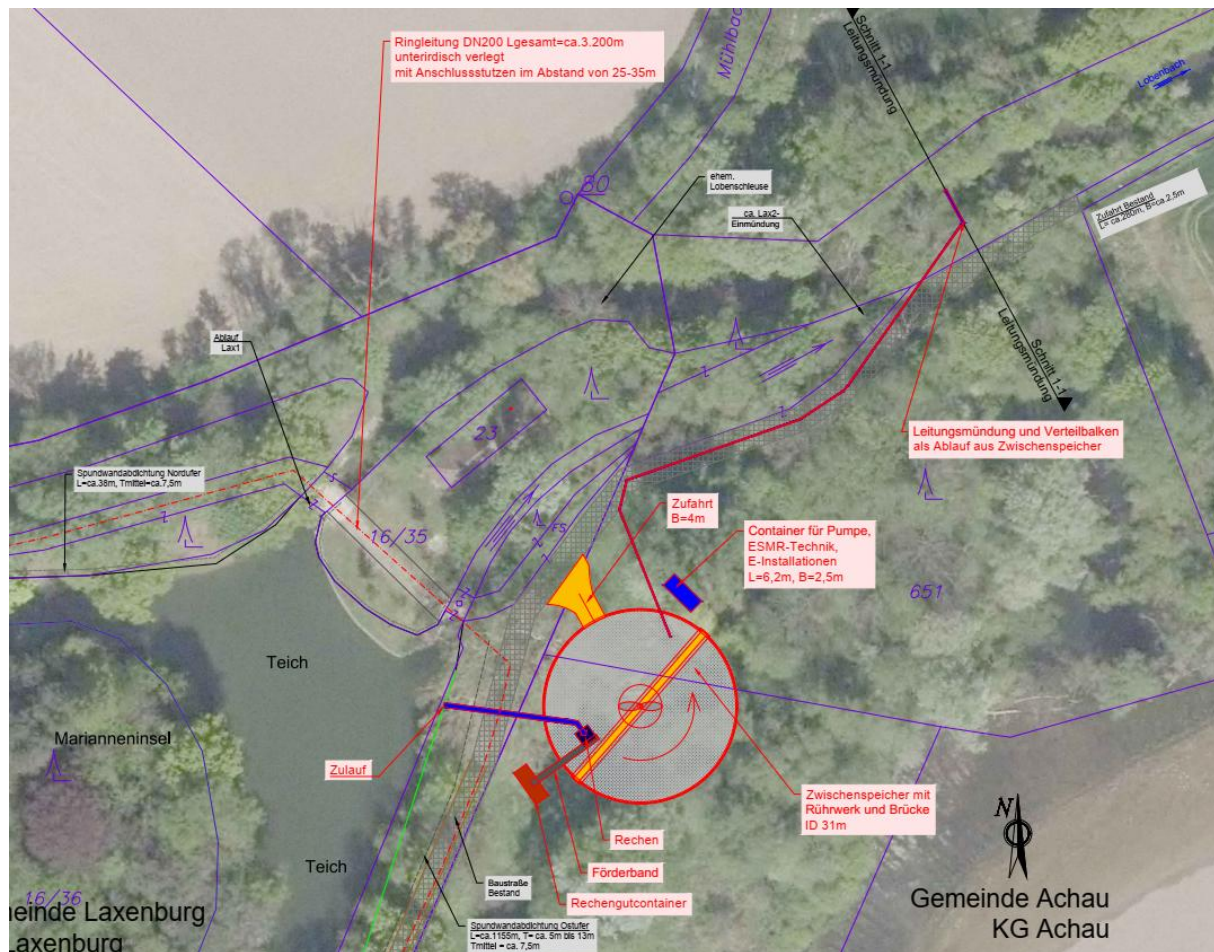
Lageplan der technischen Einrichtungen im Nordbereich des Teiches
